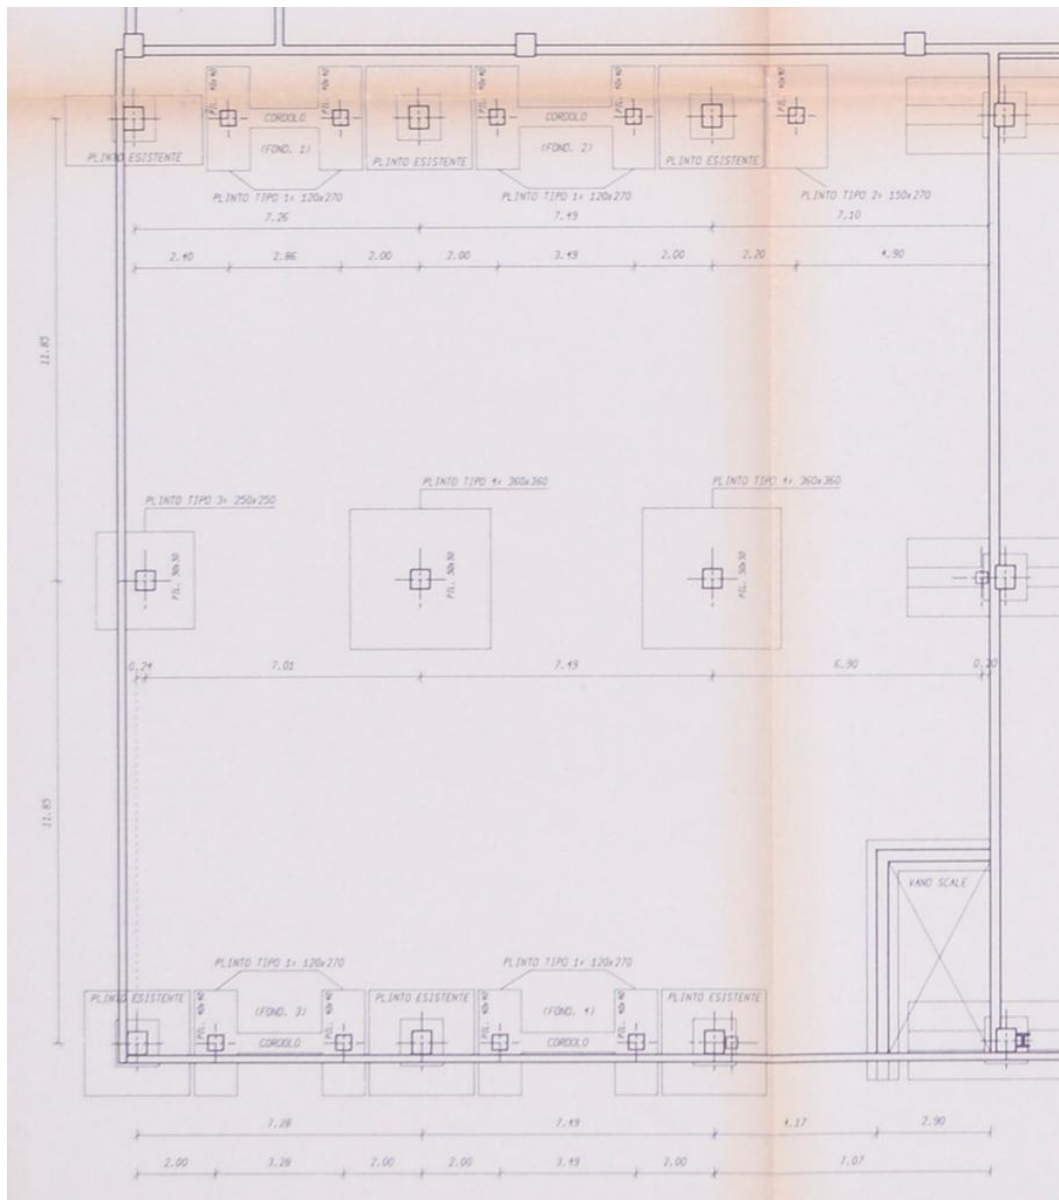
Particolare di A.1996.cap.sa.T02 - Strutture di fondazione e pilastri eseguiti in opera - Pianta fondazioni
